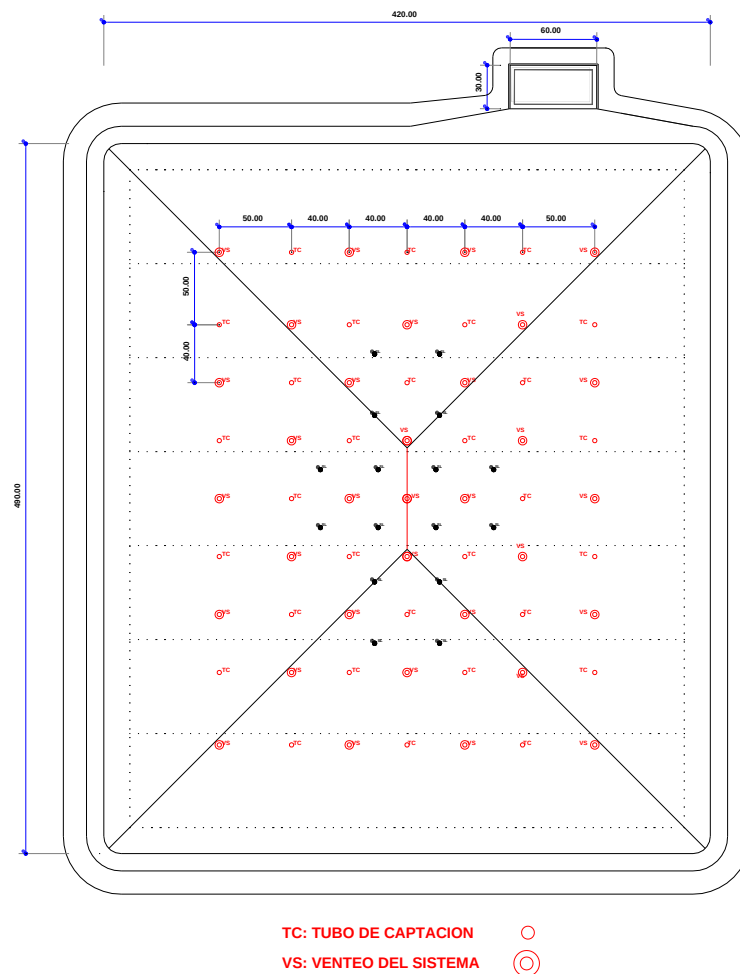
Distribución de las Chimeneas de venteo de Biogás.
